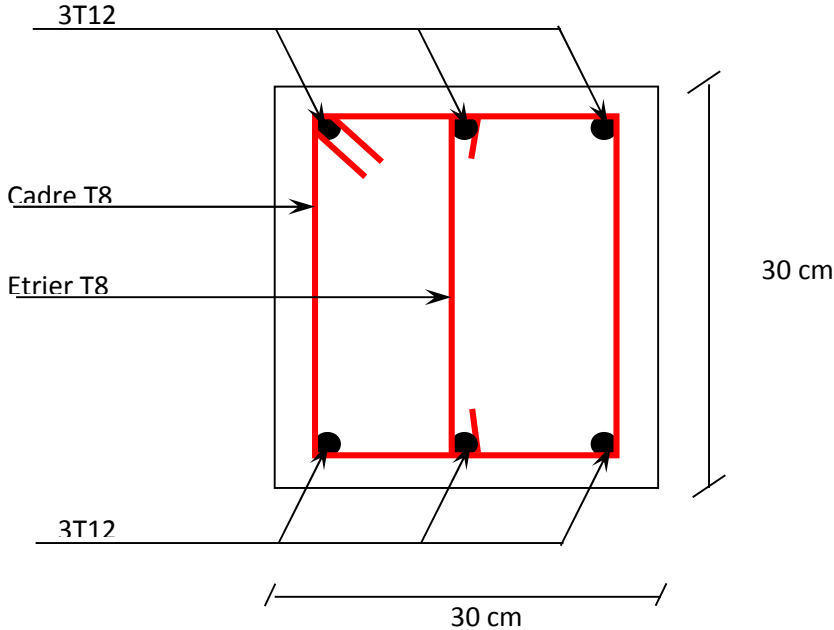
Schéma de ferrailage de la poutre de chaînage
